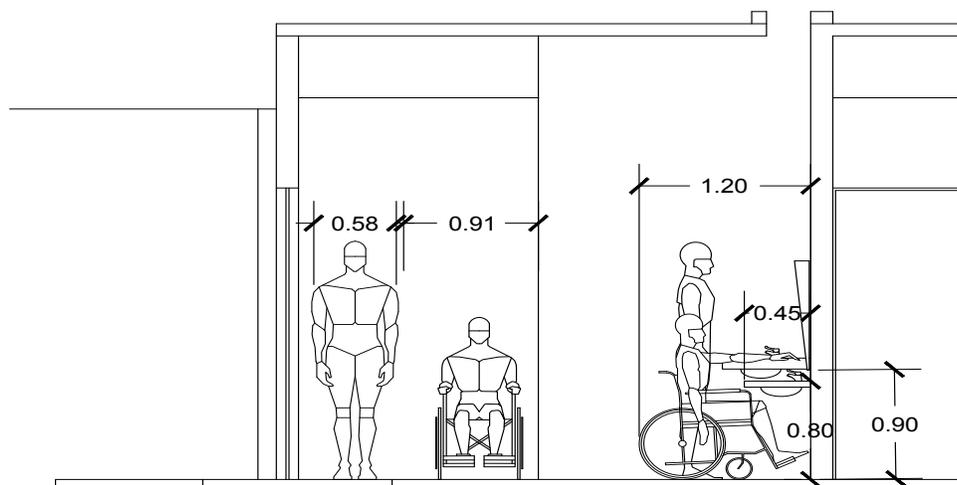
Planta del área de cenadores, elaboración: Ignacio Medina Romero
